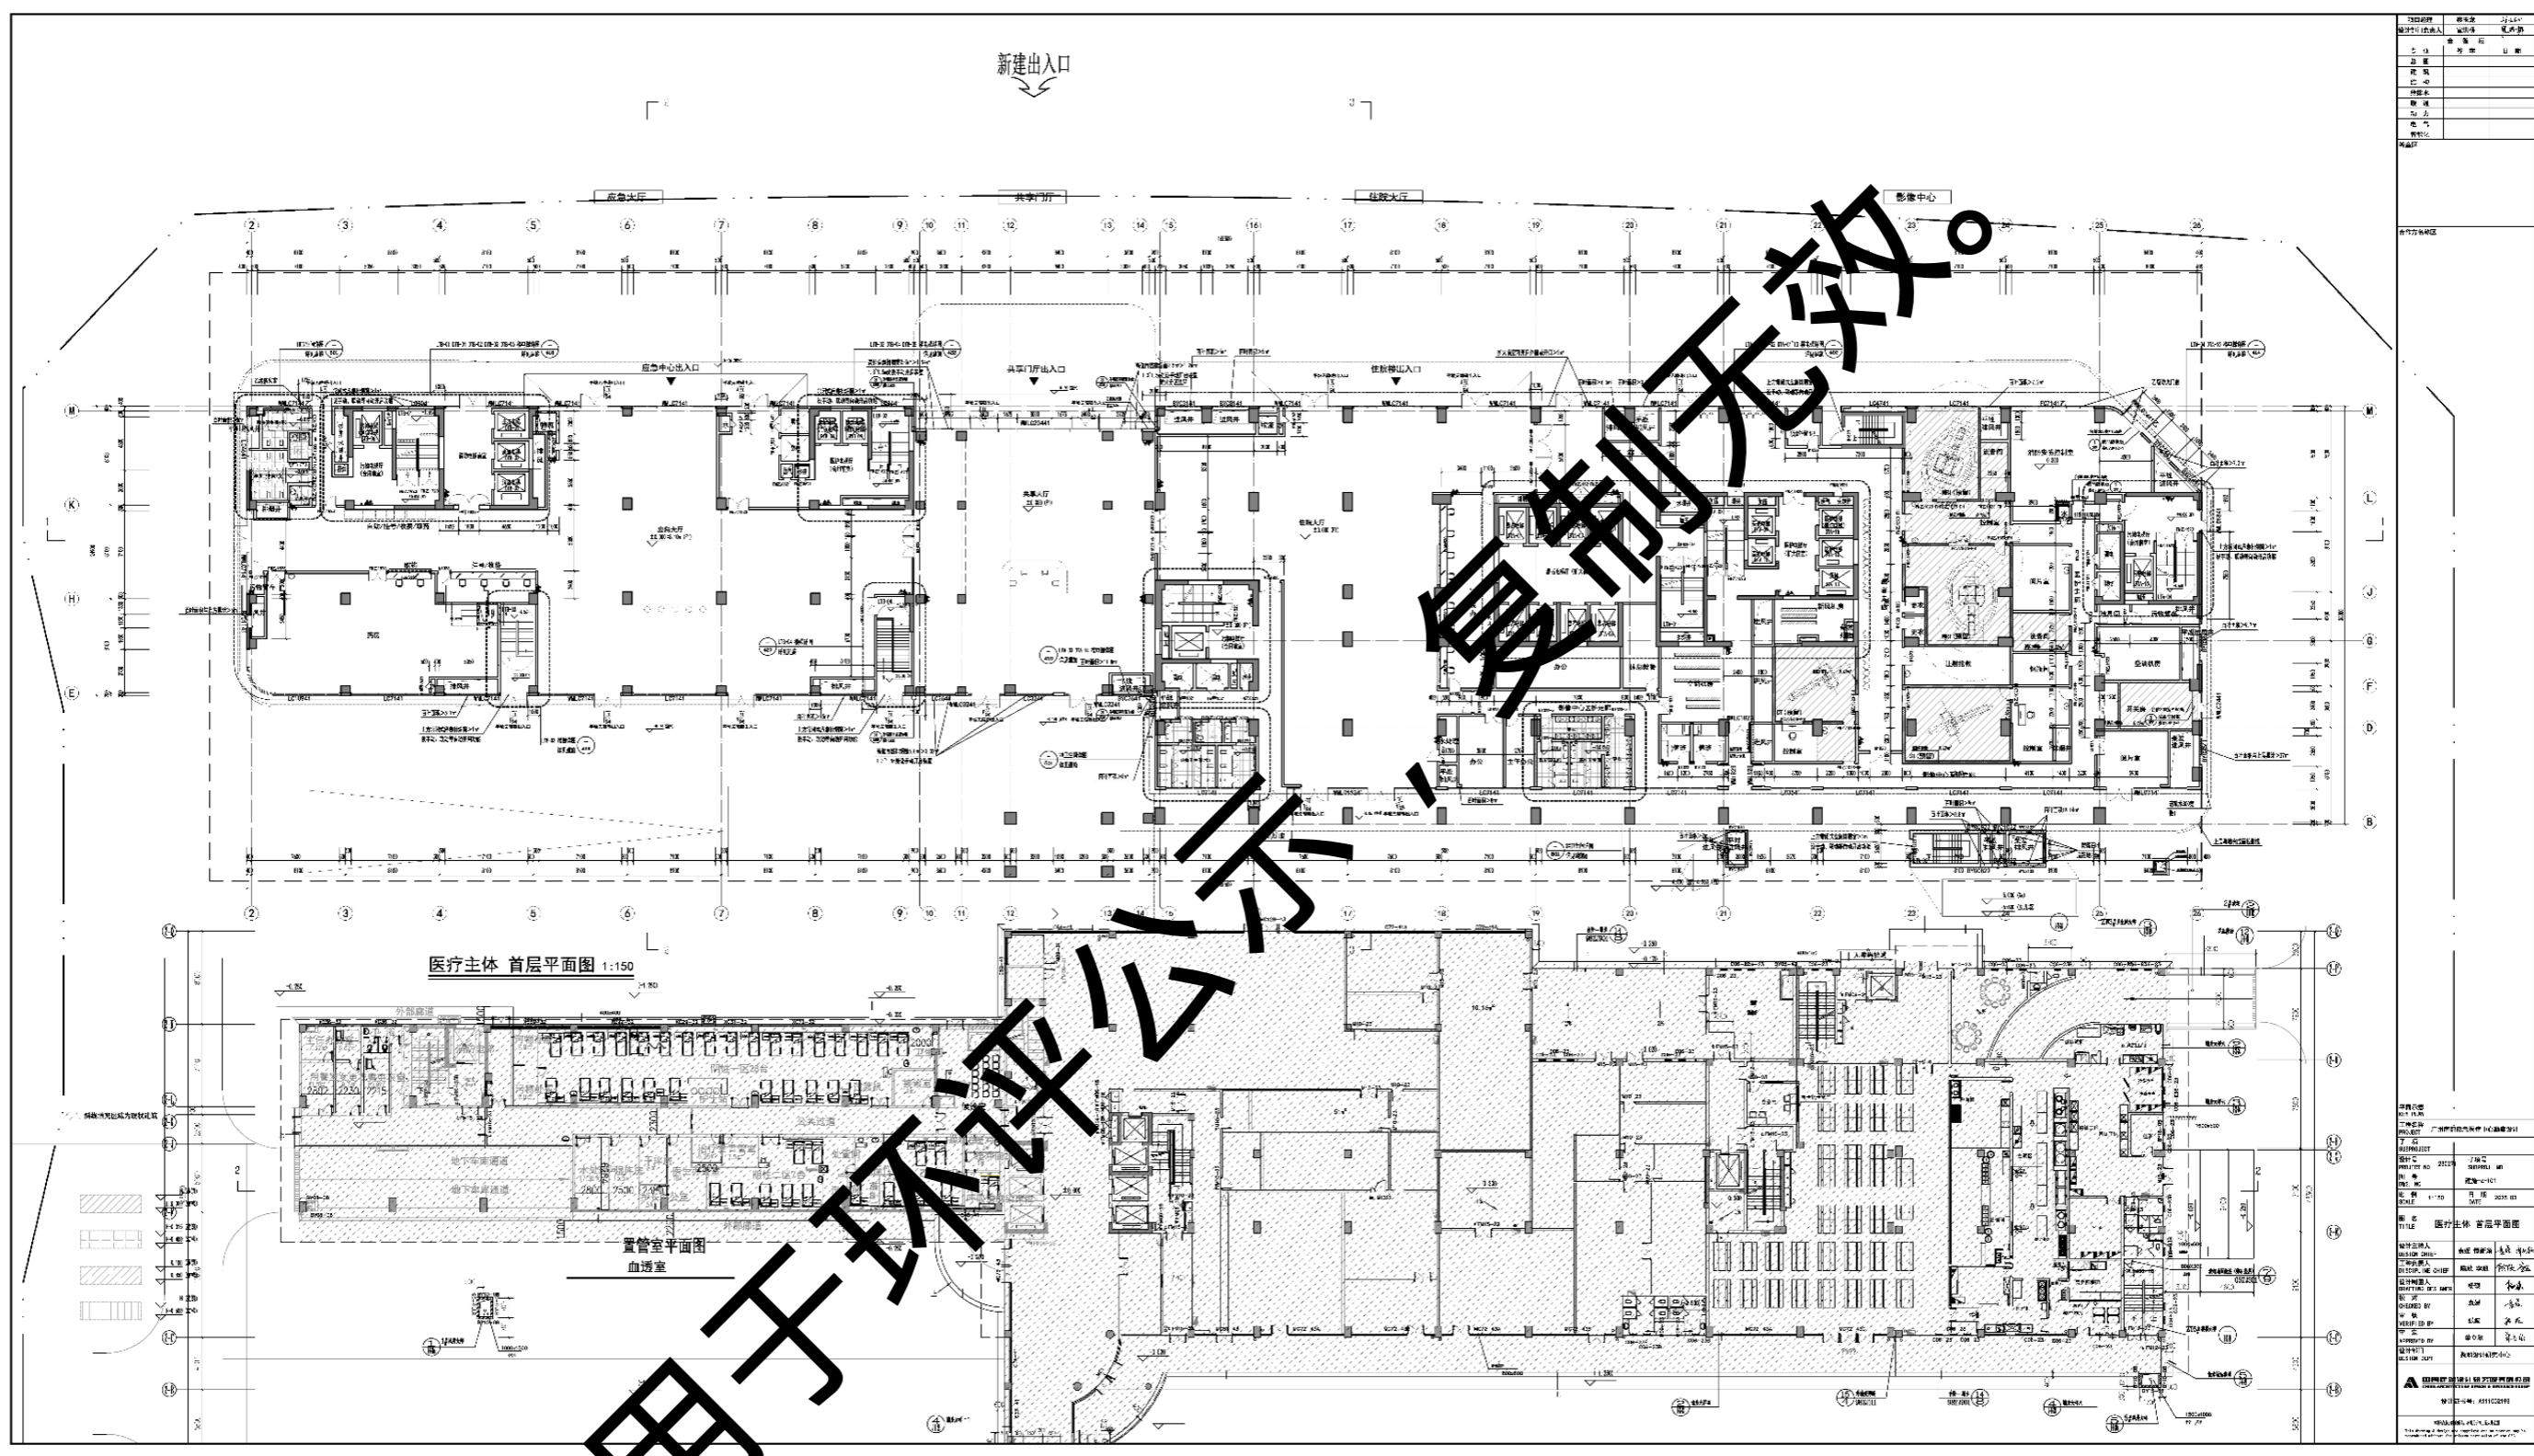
本项目新建应急中心楼 1F、住院综合楼 1F 平面布置图
